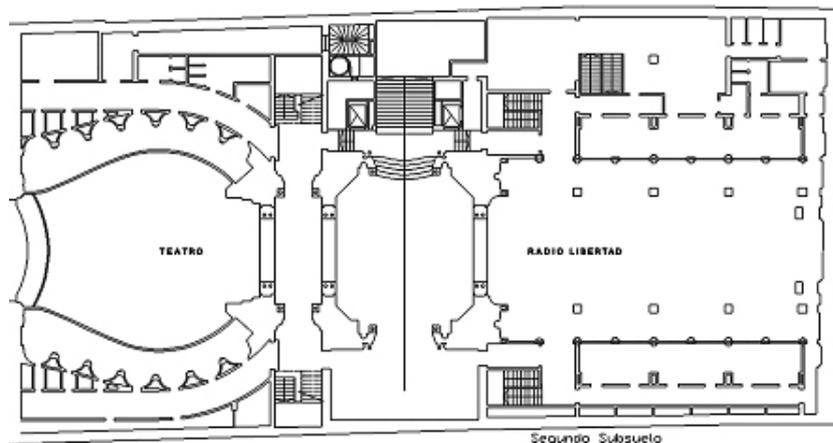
Planta del subsuelo de la galería. (Lemos)
